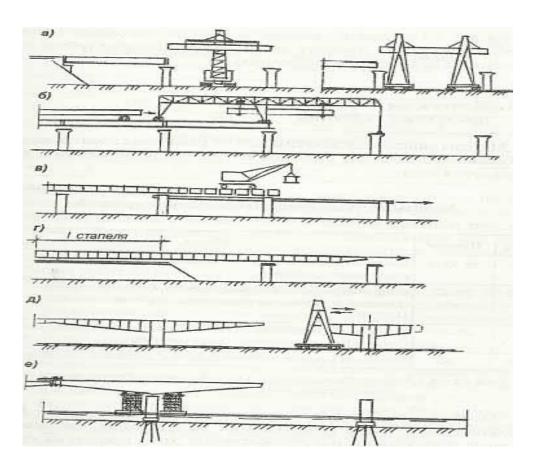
Технологии монтажа пролетных строений из сборного железобетона: а — монтаж балок с земли; б — монтаж балок со смонтированного пролетного строения; в — монтаж неразрезных балок на перемещающихся подмостях; г — продольная надвижка неразрезного пролетного строения; д — навесной монтаж; е — наплавной монтаж пролетного строения секциями («птичками»)
